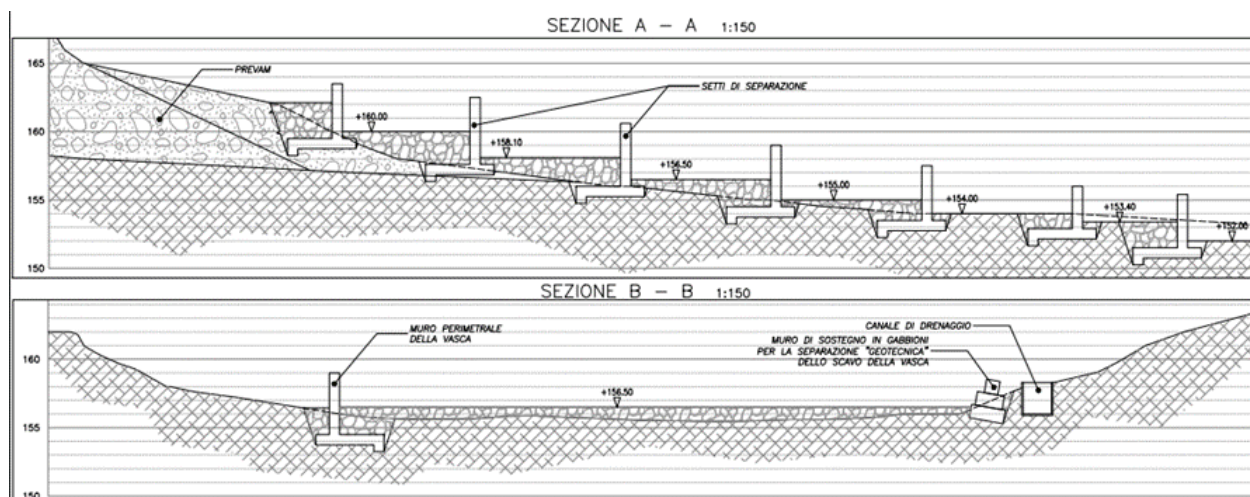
SEZIONE TIPO DELLA VASCA DI SEDIMENTAZIONE
